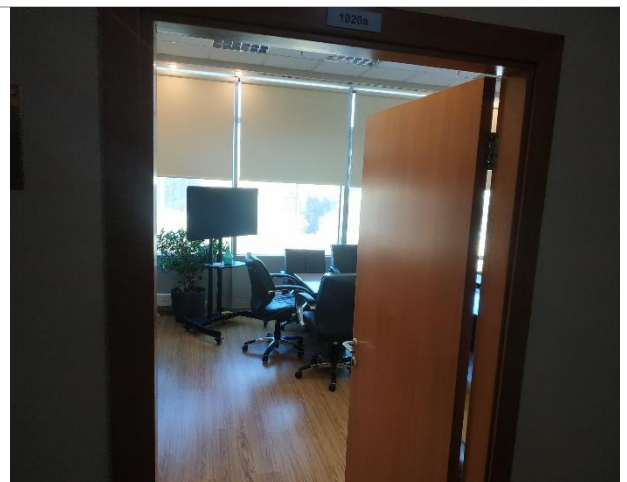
Фрагменты внутренних помещений 10-11 этажей
